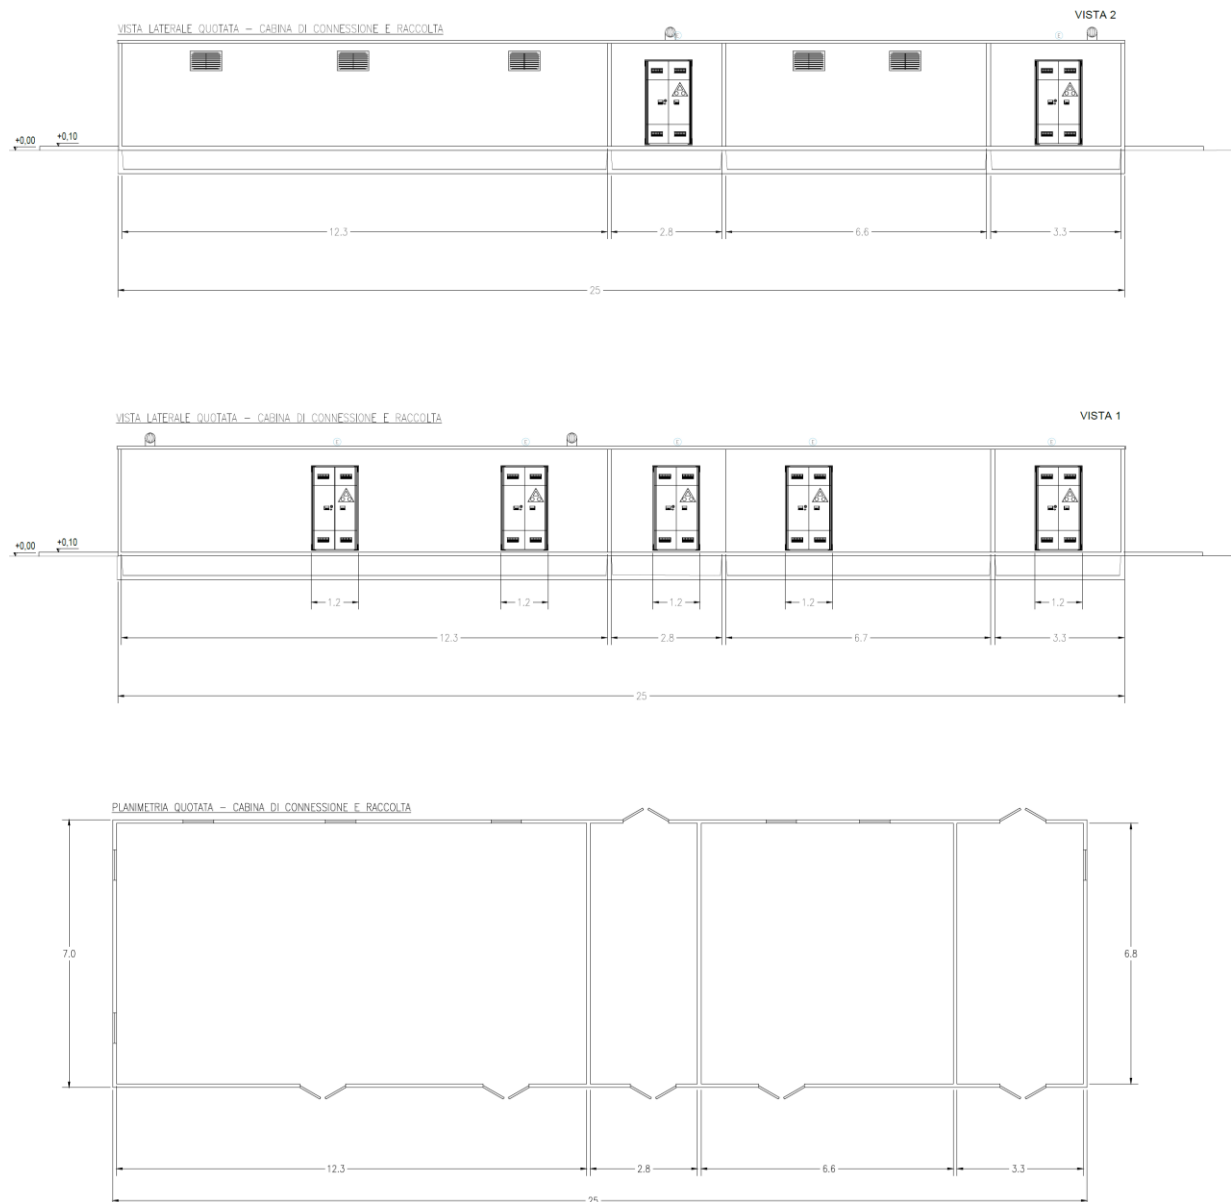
VISTE IN PIANTA E PROSPETTO CABINE DI RACCOLTA
